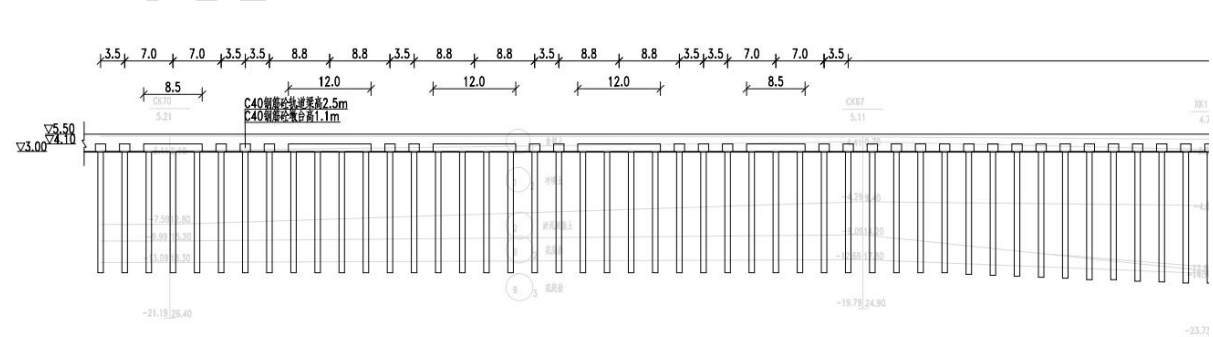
龙门吊轨道梁桩基布置纵断面图
